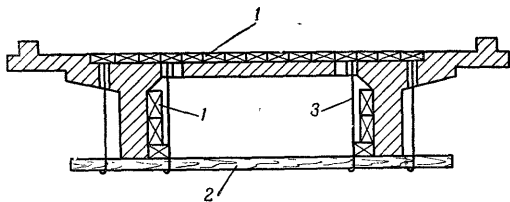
Крепление наружных зарядов на конструкциях железобетонного моста:
